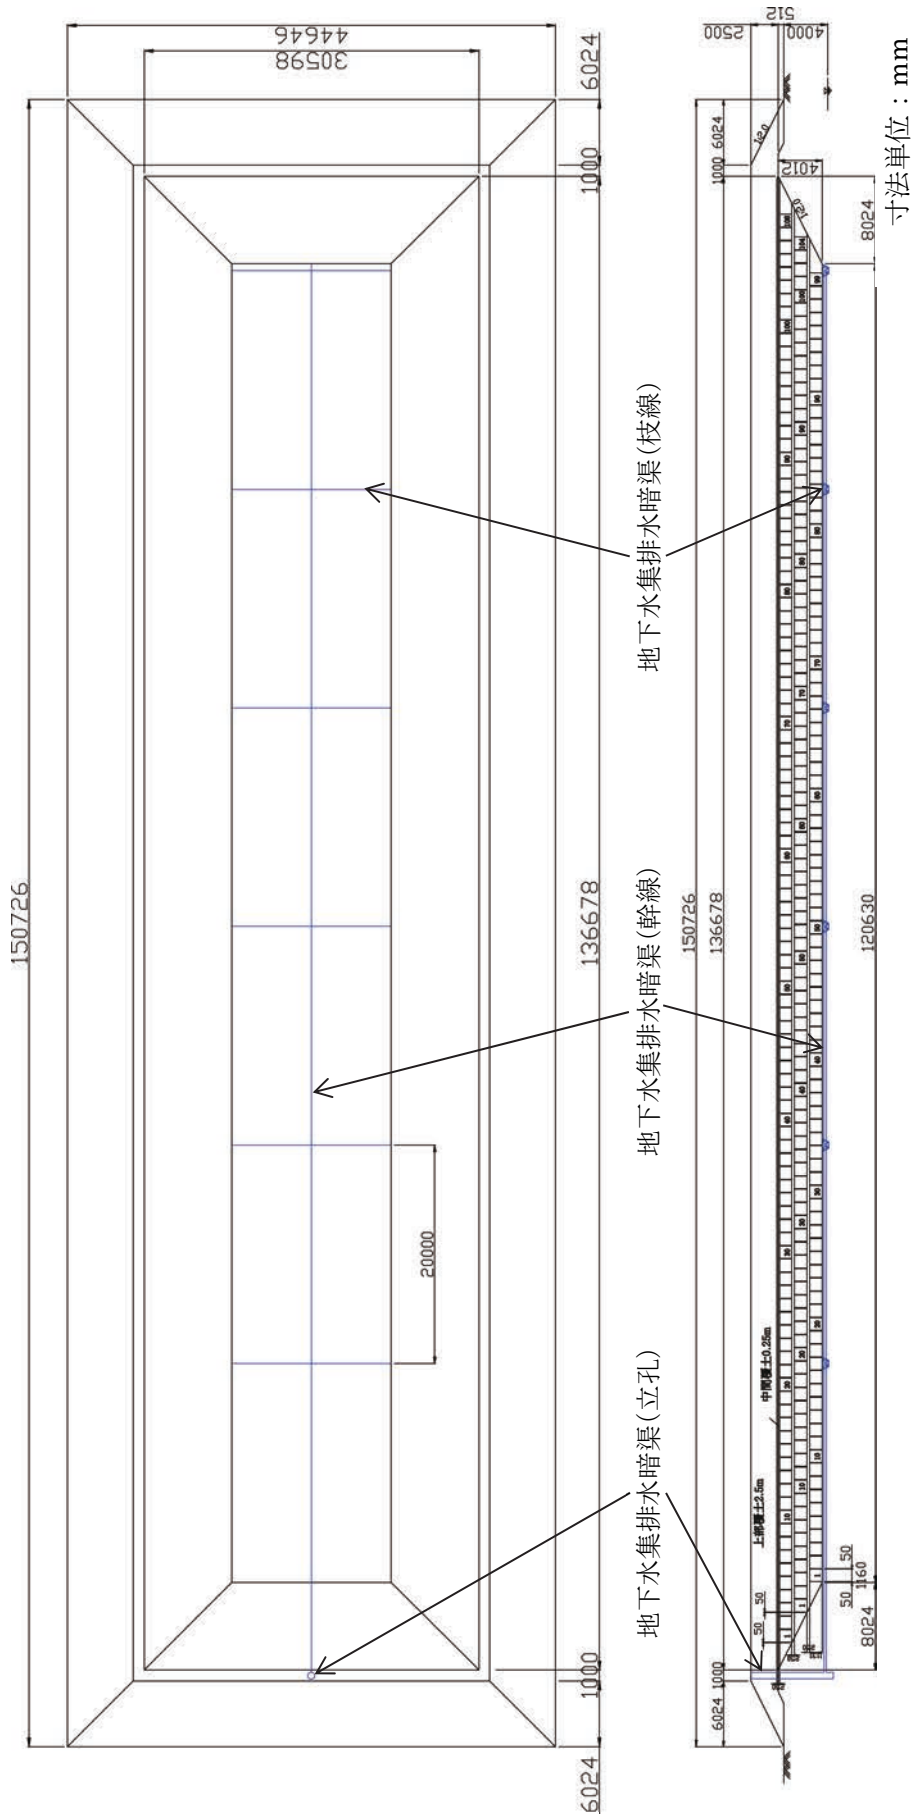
安定型トレンチの底部平面図、縦断面図 (P埋設地)
